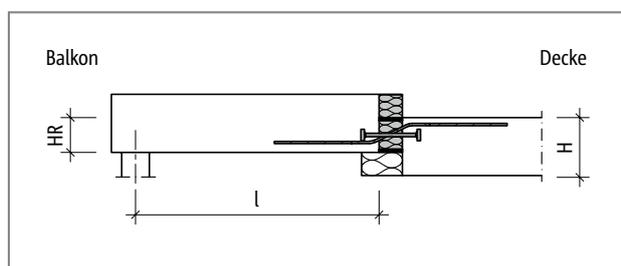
Schöck Isokorb® Typ QL-OD: Statisches System
